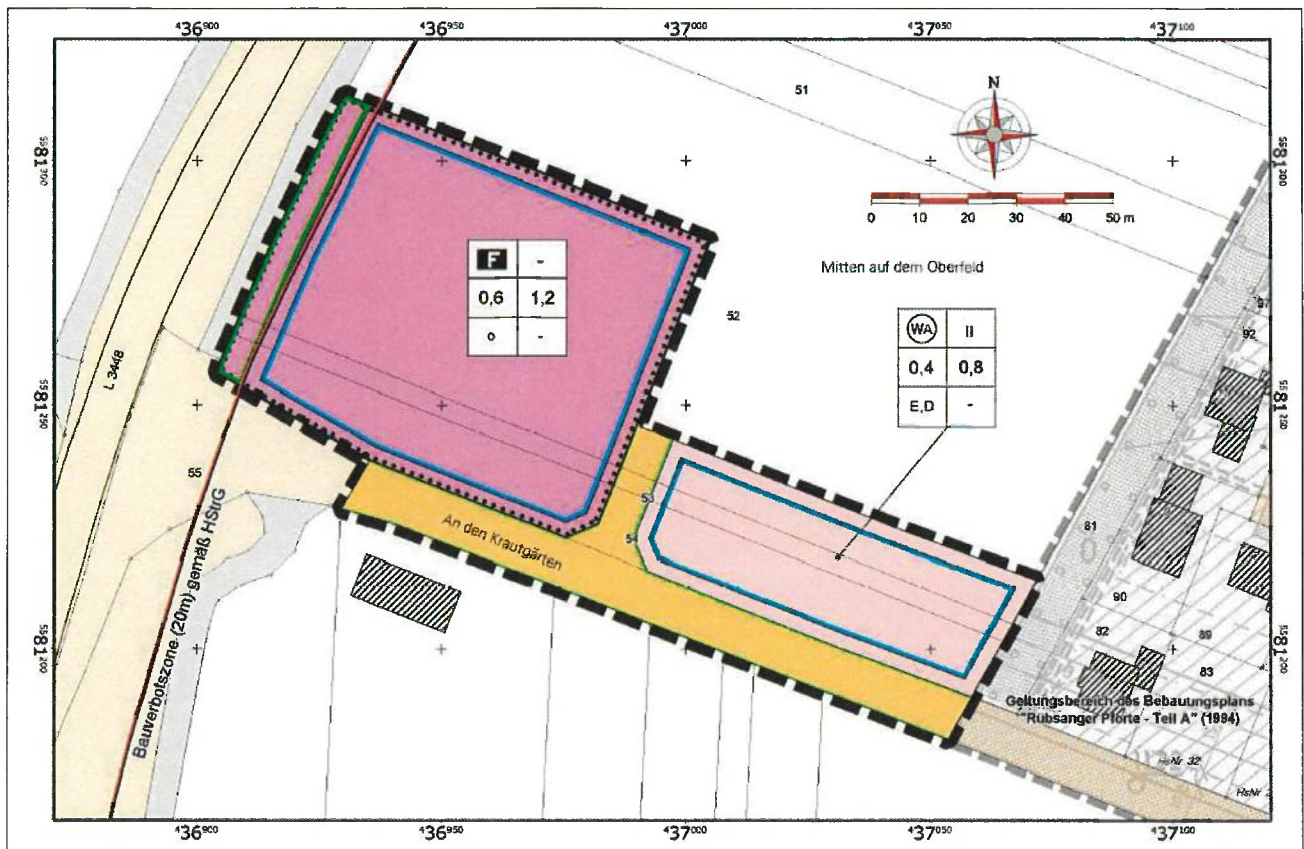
Bebauungsplan „Auf dem Oberfeld“.
